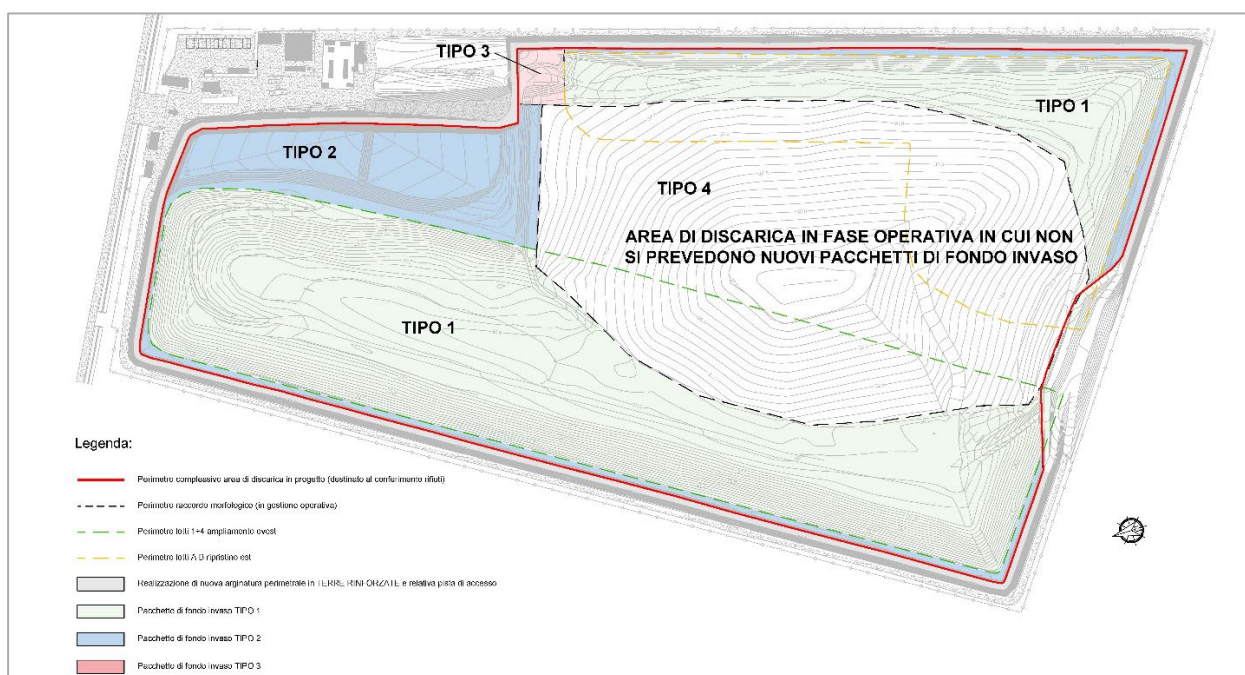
Planimetria generale di progetto del fondo invaso – Tav.3.8
